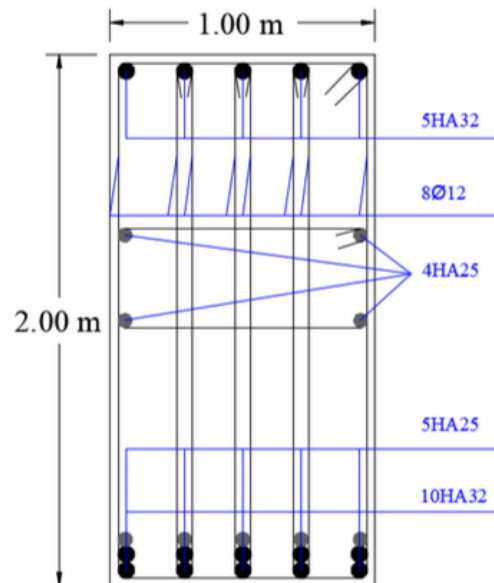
Schéma de ferrailage de la nervure du radier sur appui
